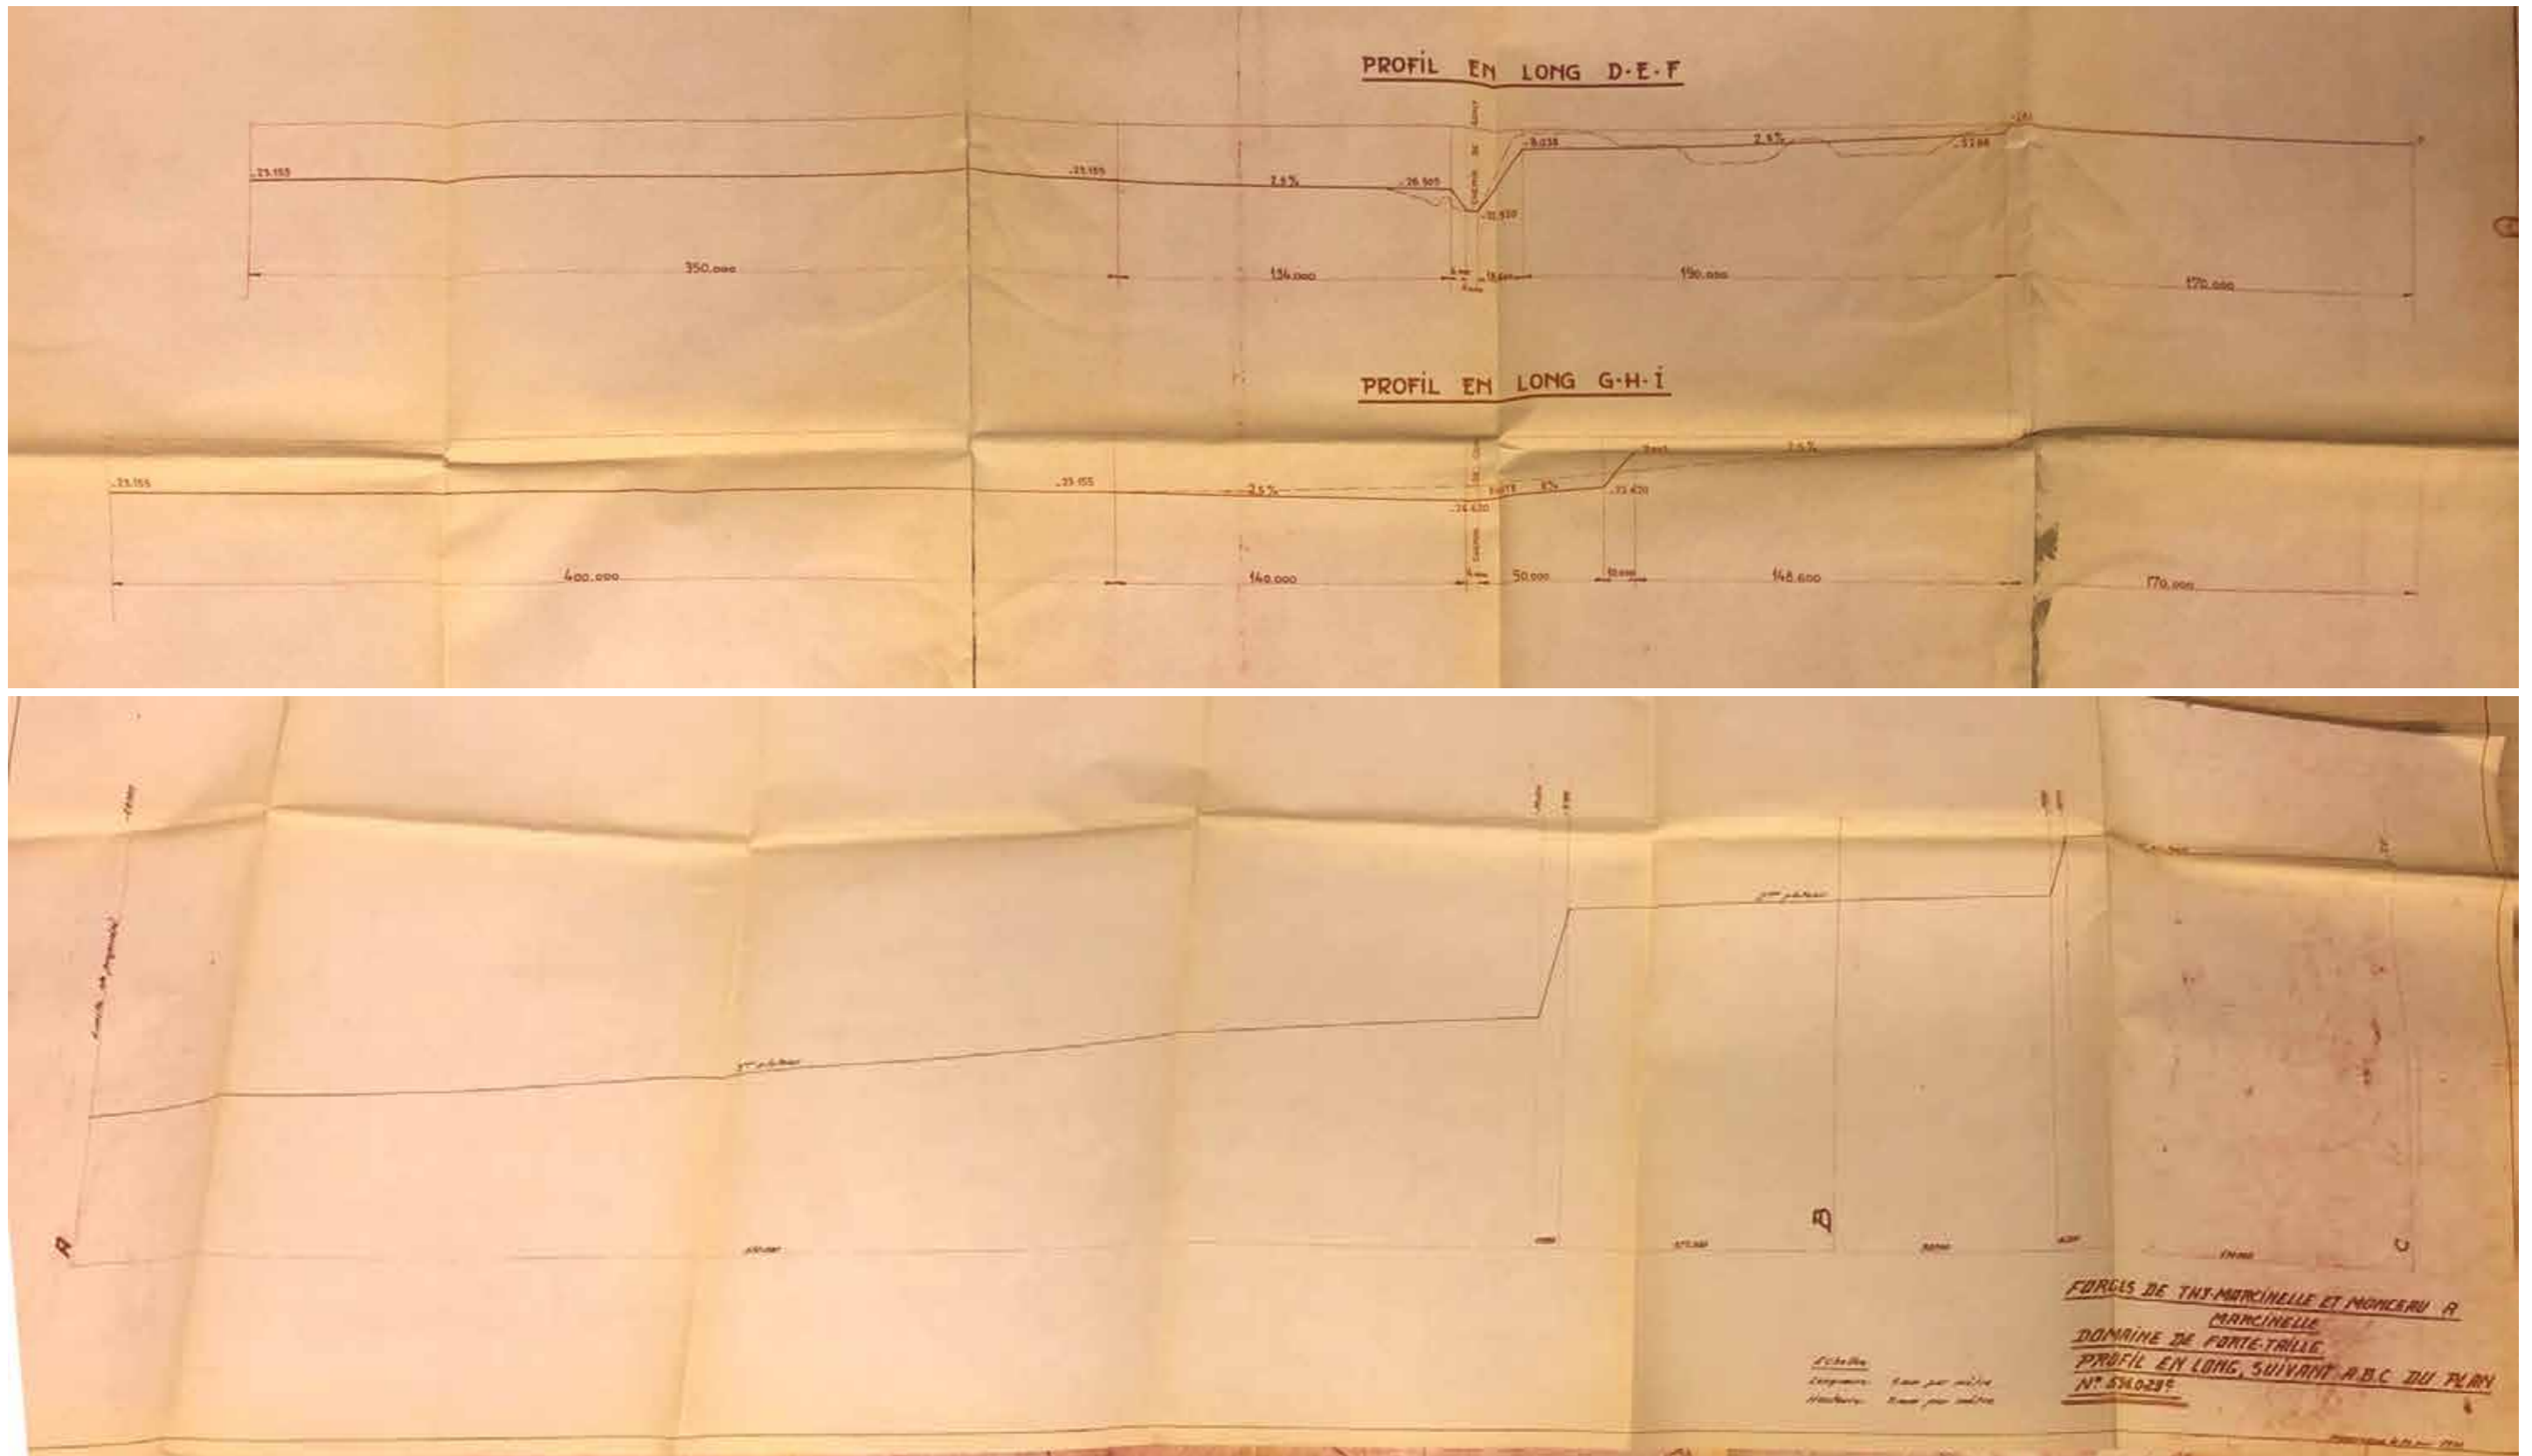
Terreinsnedes van de site volgens snedelijnen inplantingsplan, zonder gebouwen. Bron: Archief Bois du Cazier
